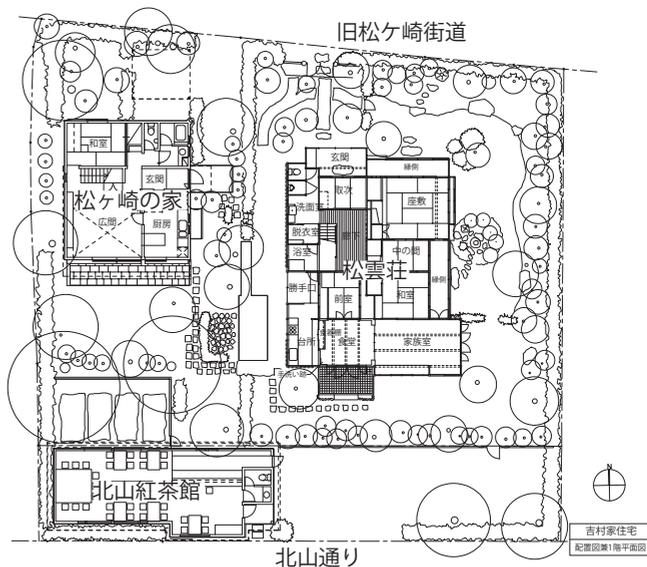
松雲荘・松ヶ崎の家・北山紅茶館 配置図・1階平面図
